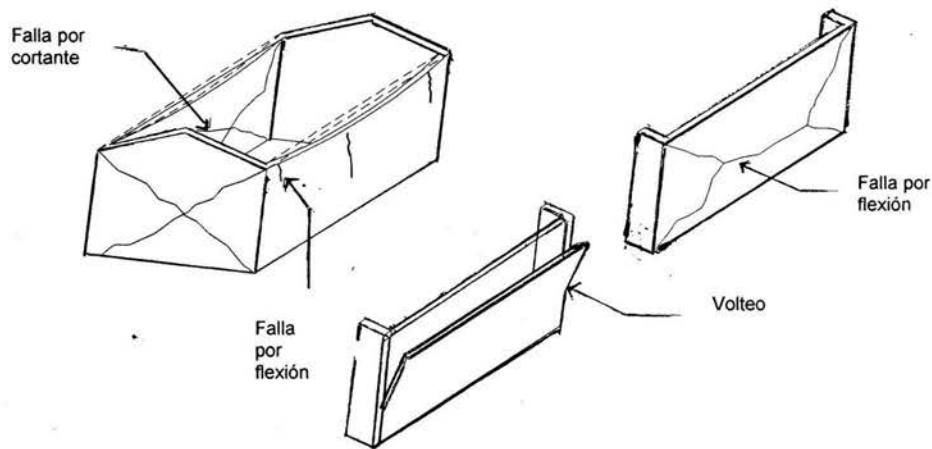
Daños en muros de mampostería (Iglesias, Robles 1992)
